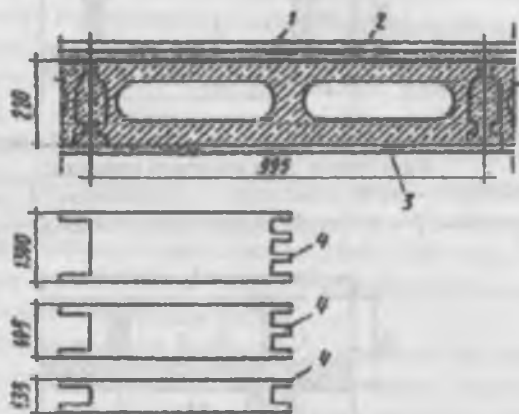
Сборные железобетонные пустотные настилы для замены перекрытий:
